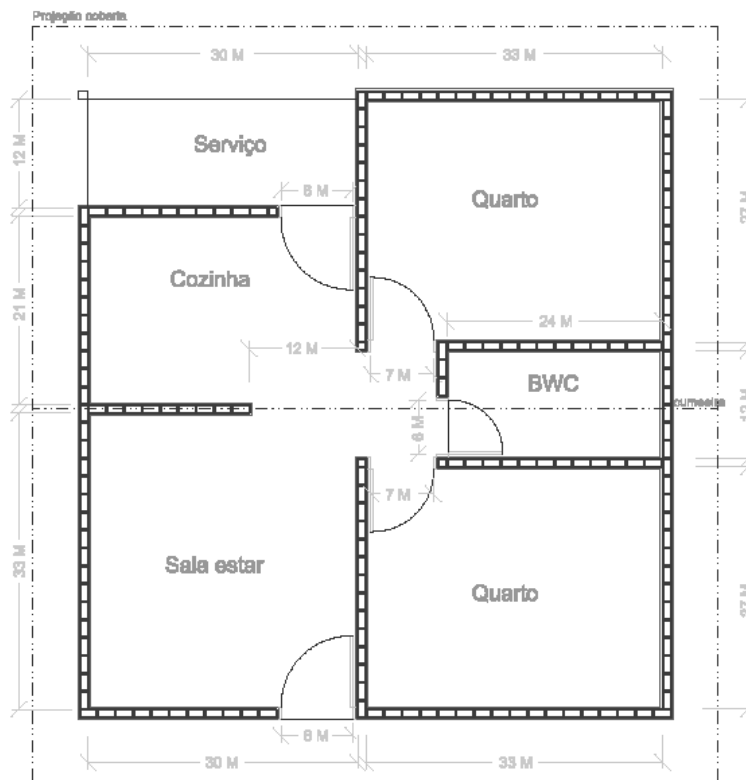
Planta baixa de proposta da habitação para Viçosa-AL, usando a coordenação modular.
